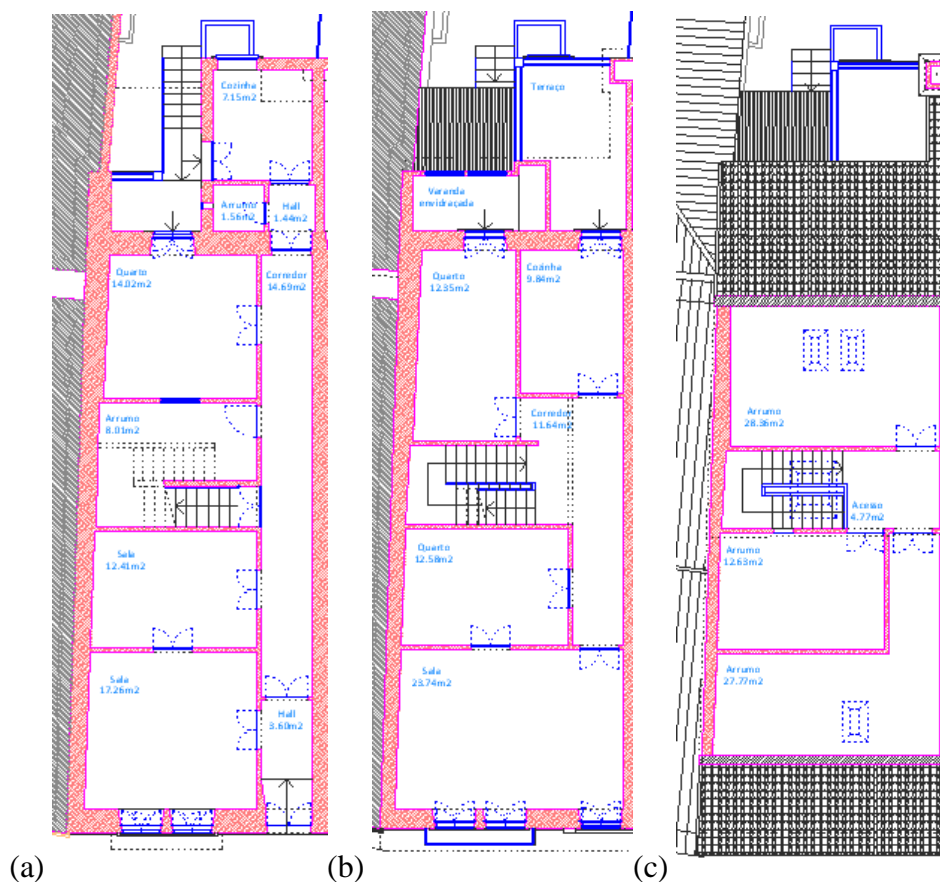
Planta baixa dos pavimentos 1, 2 e 3, respectivamente (SRU, 2023).
